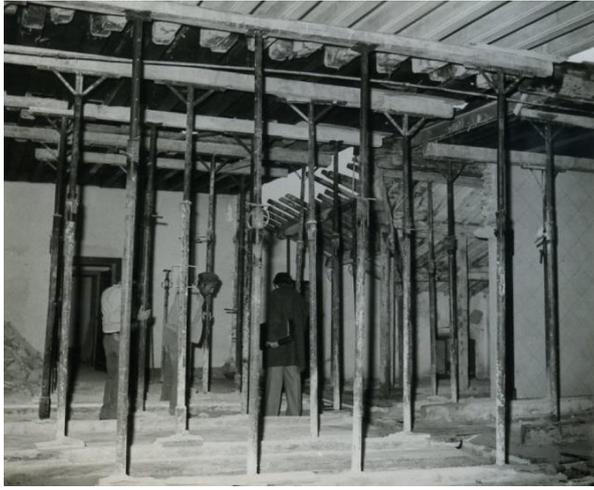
Foto del cantiere di ristrutturazione della villa realizzato negli anni Settanta (archivio privato arch. Nasi, documentazione fornita dall'Associazione La Quarta Luna).
